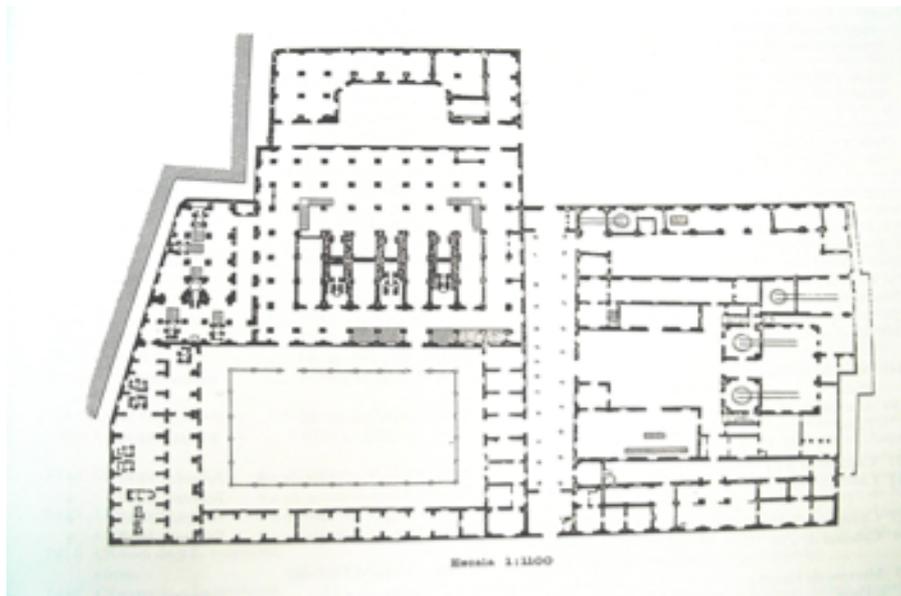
Planta actual de la Fundición de Artillería de Sevilla²²²
